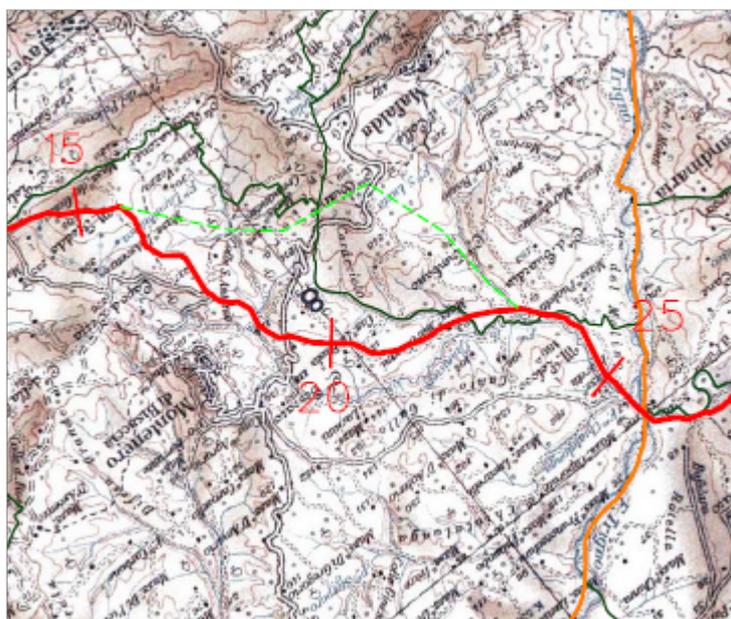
b: Alternativa No. 2 – Tratto da km 16 a km 22
